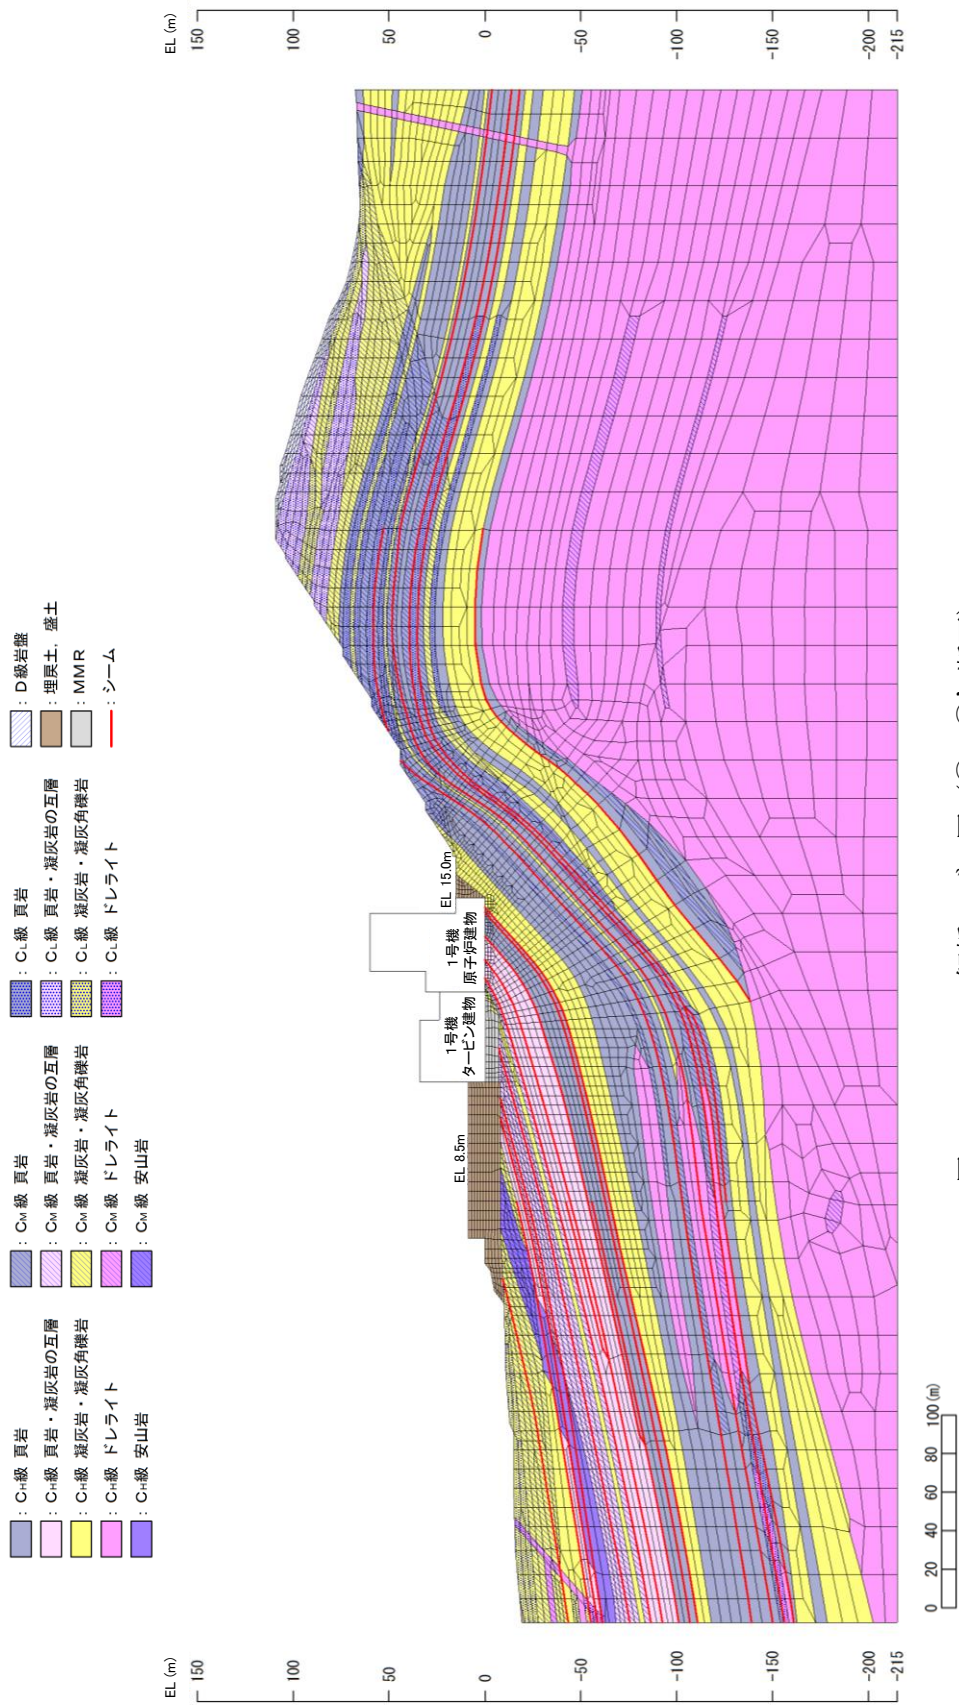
解析モデル図 (④-④' 断面)
